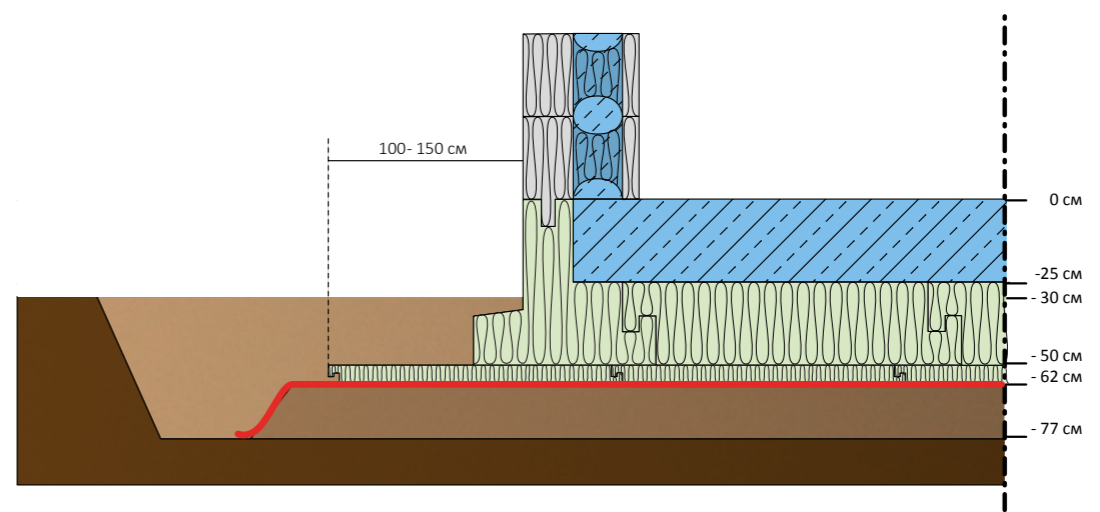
Схема устройства фундаментной плиты с использованием дополнительной теплоизоляции.
